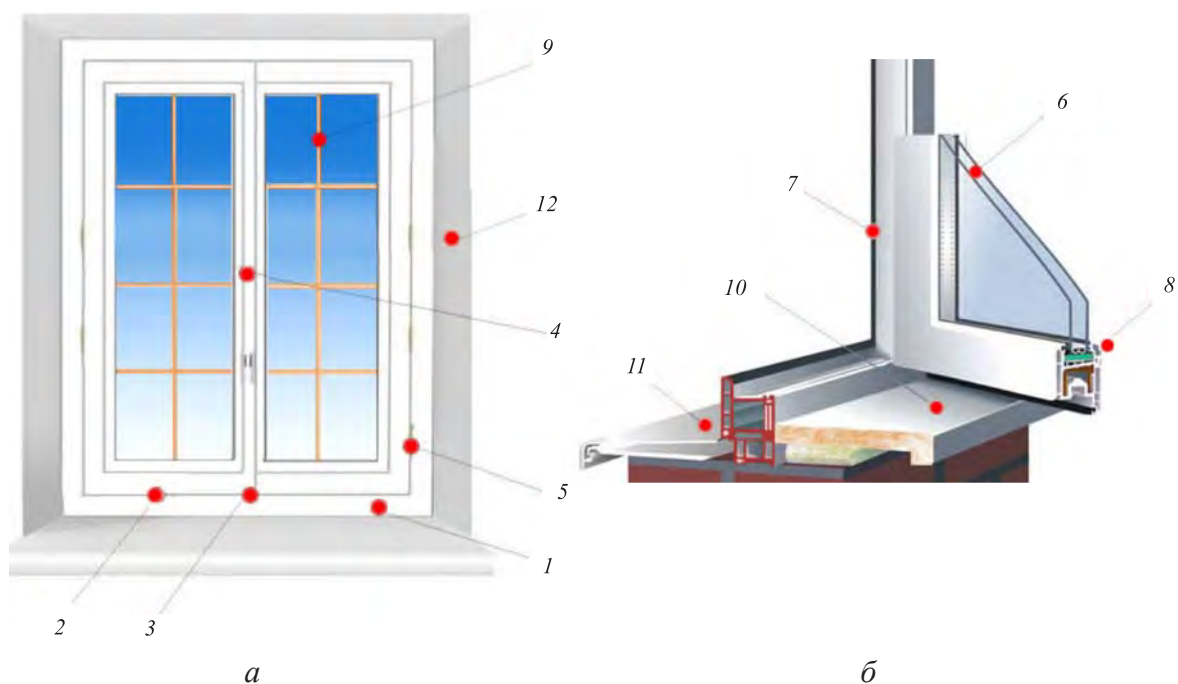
Детали (а) и разрез (б) окна: 1 — рама; 2 — створка; 3 — импост; 4 — шульп; 5 — фурнитура; 6 — стеклопакет; 7 — уплотнители; 8 — штапик; 9 — раскладка; 10 — подоконник; 11 — отлив; 12 — откосы
